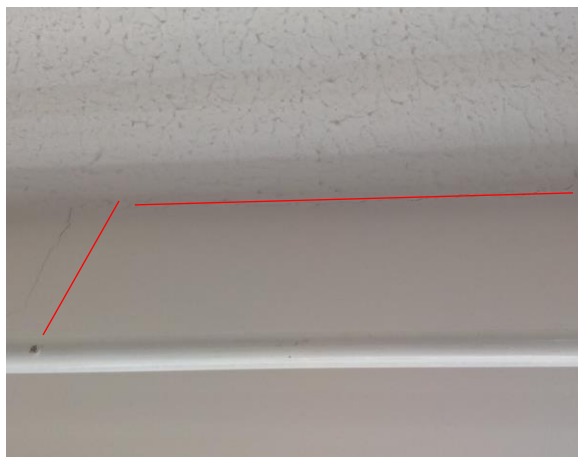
Fissuras sob a laje do piso superior (VISTA A)
